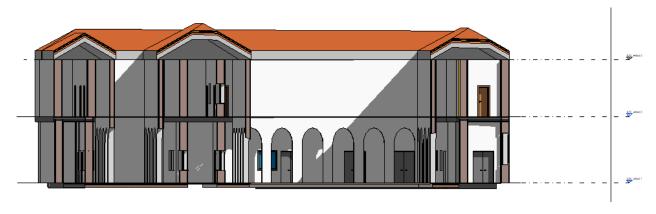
Plano de corte A – Fuente: Elaboración Propia
